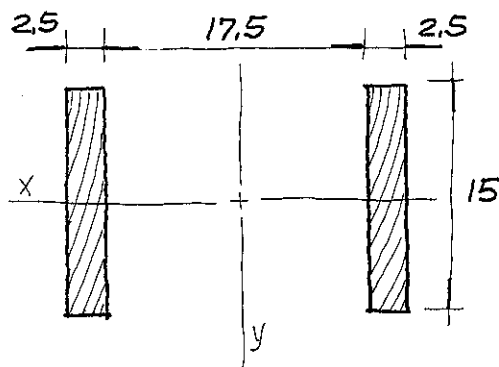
Seção da Diagonal Viga/Pilar
